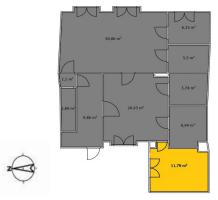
Vista del plano de la primera planta de la casa Mariano Amigó: situación de la habitación sur-oeste.
